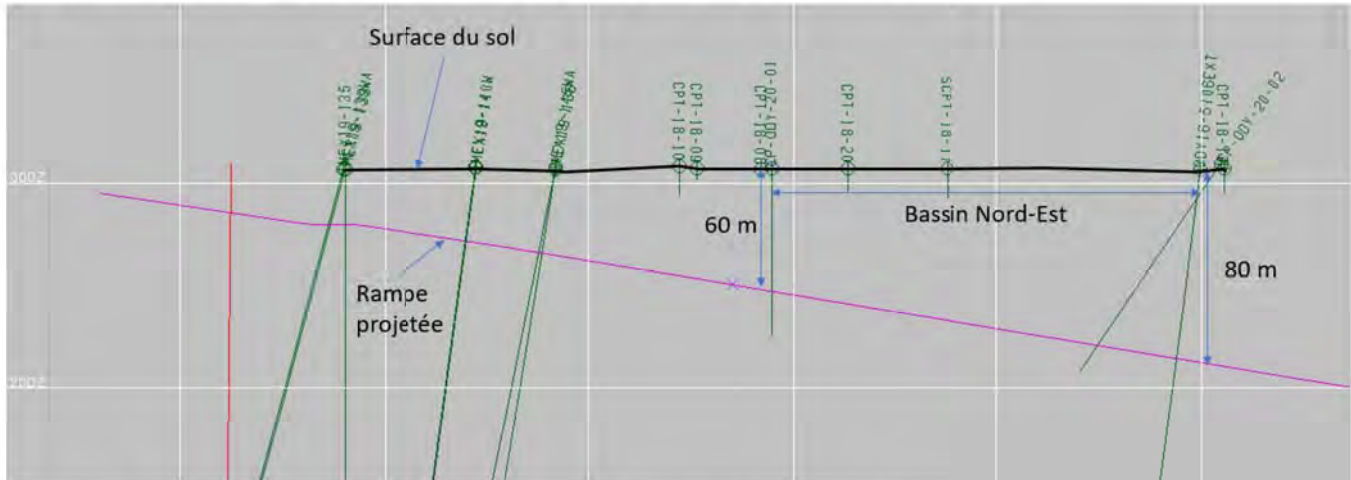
Projection longitudinale de la rampe planifiée avec vue vers le nord
